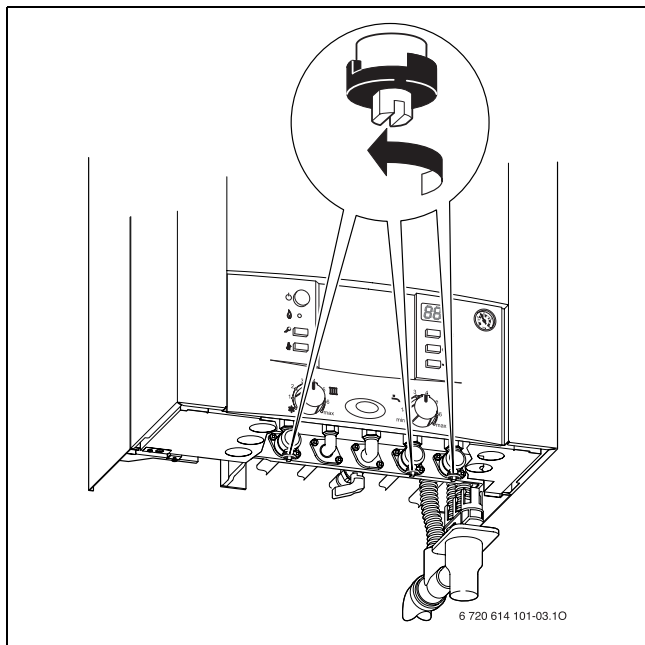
Vista caldaia con piastra d'installazione, accessorio nr. 893/18
